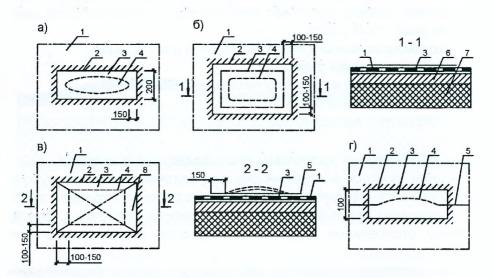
Устройство заплат на рулонных кровлях в местах: а-разрывов; б-разрушений (пробоины); в-вздутий; г-повреждений краев полотнищ;
